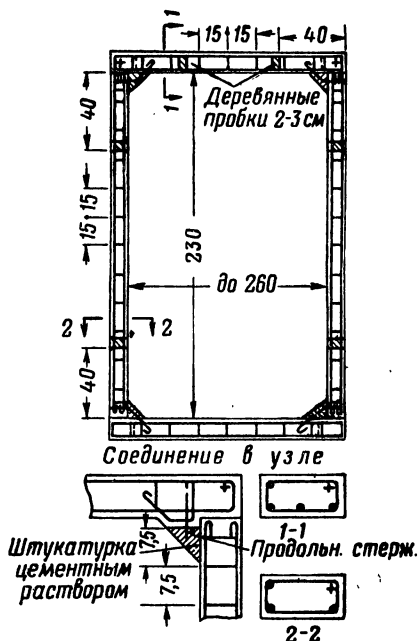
Сборная железобетонная обделка из прямоугольных рам
